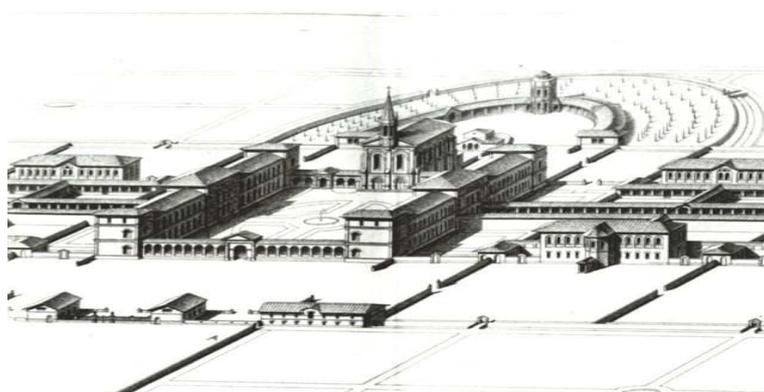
L'une des planches publiées dans la Revue Générale de l'architecture
